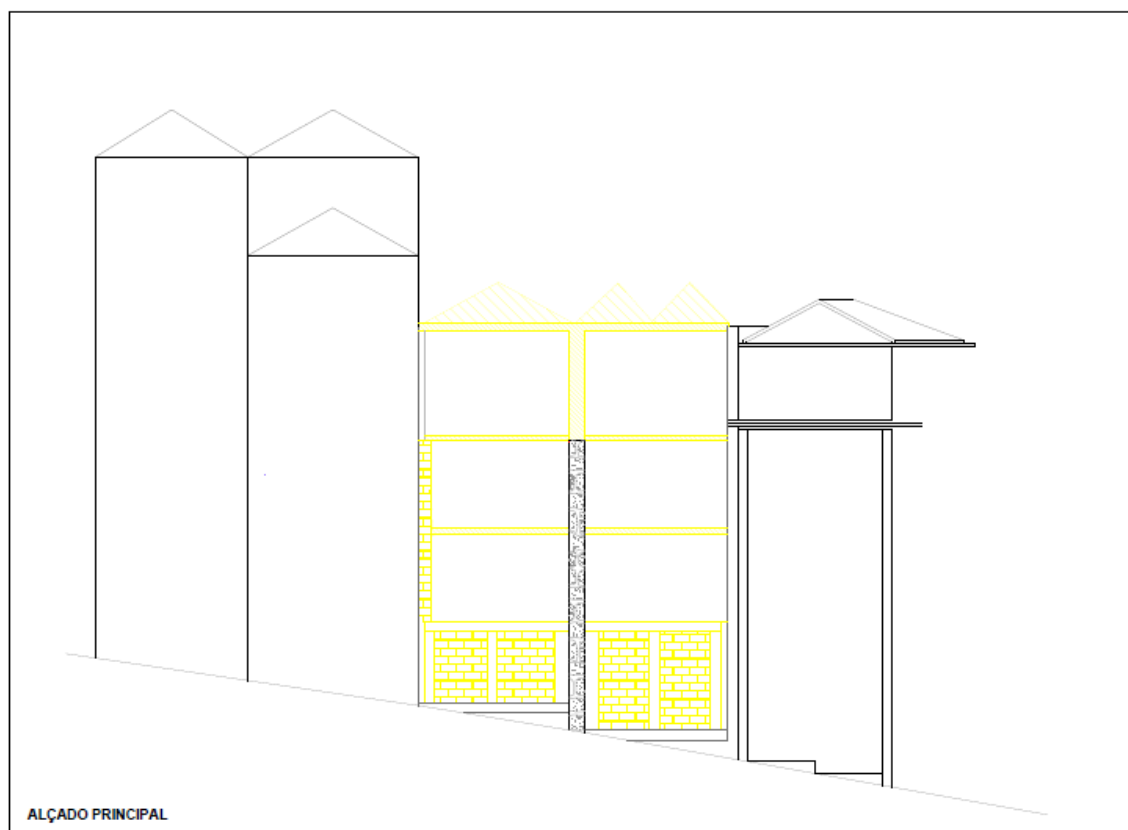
Alçado principal com elementos a demolir - Fonte: Desenhos de Arquitetura da Operação A – Projeto 1
